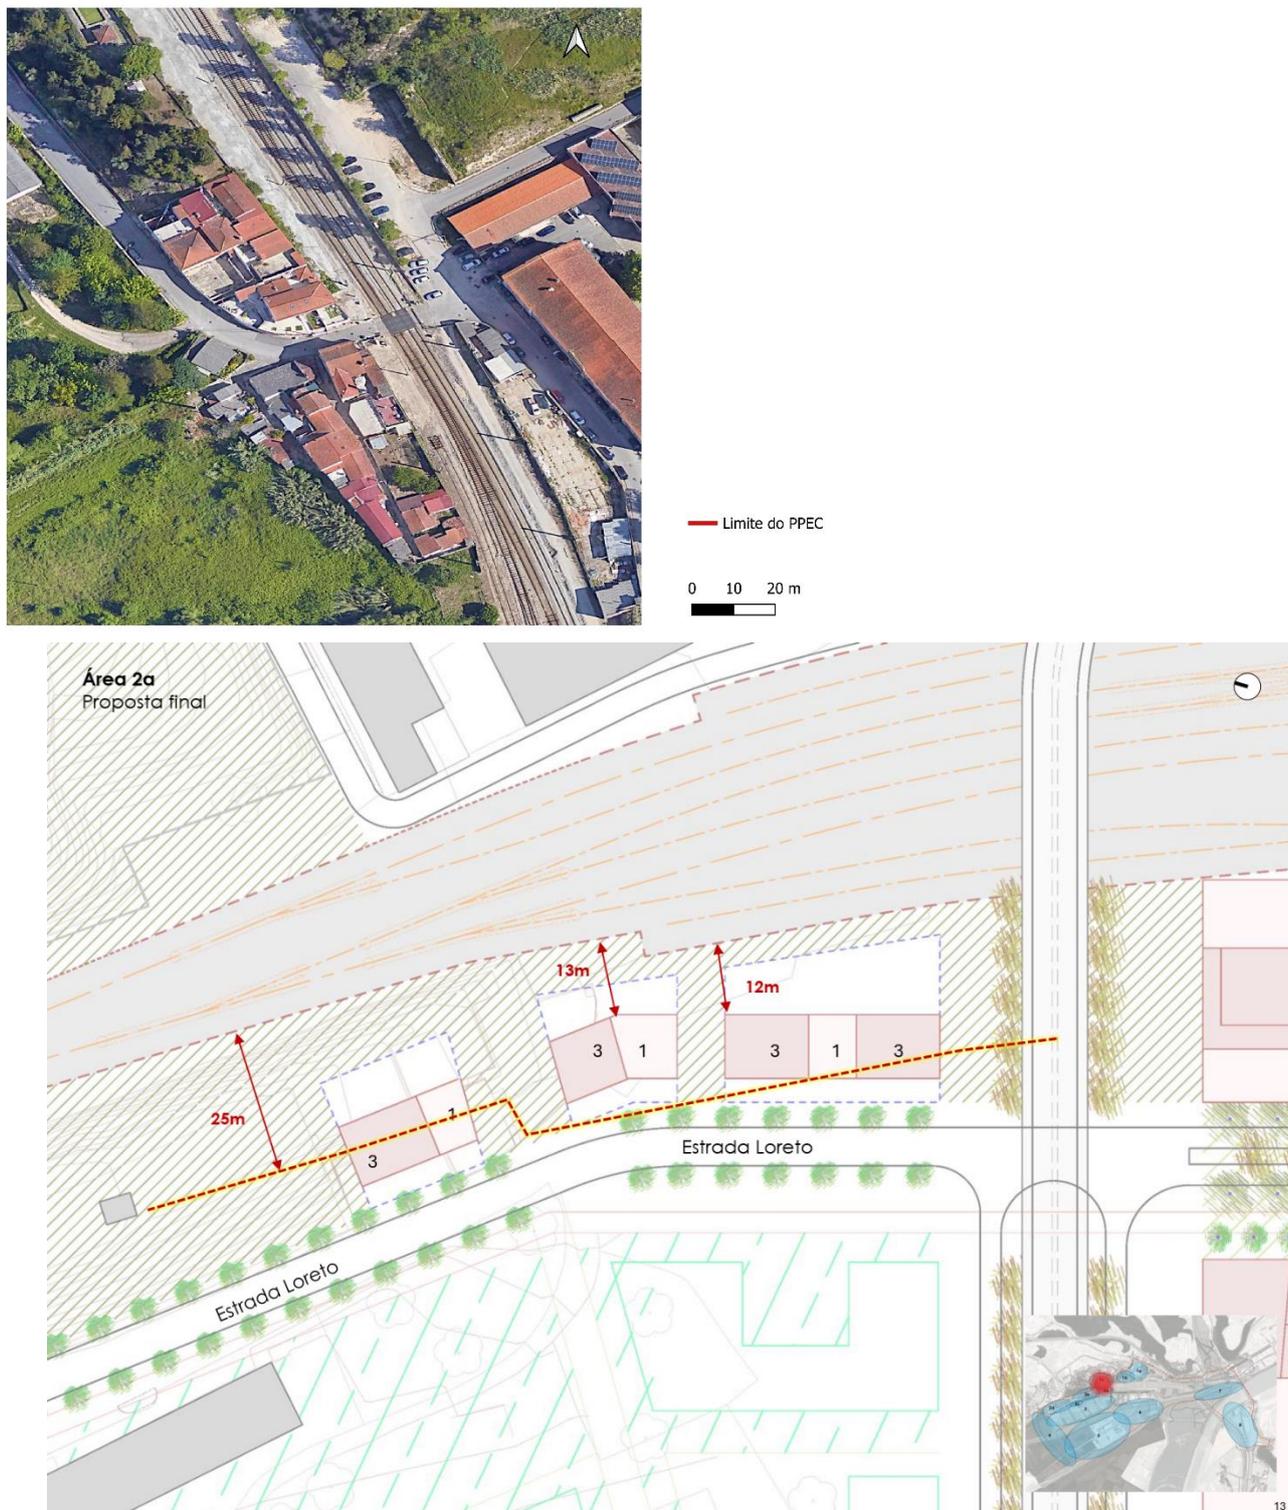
Acima: vista de satélite da área 2a. Abaixo: proposta preliminar para a zona 2a (a cinza o edificado existente, e a vermelho propostas de possível edificado).
